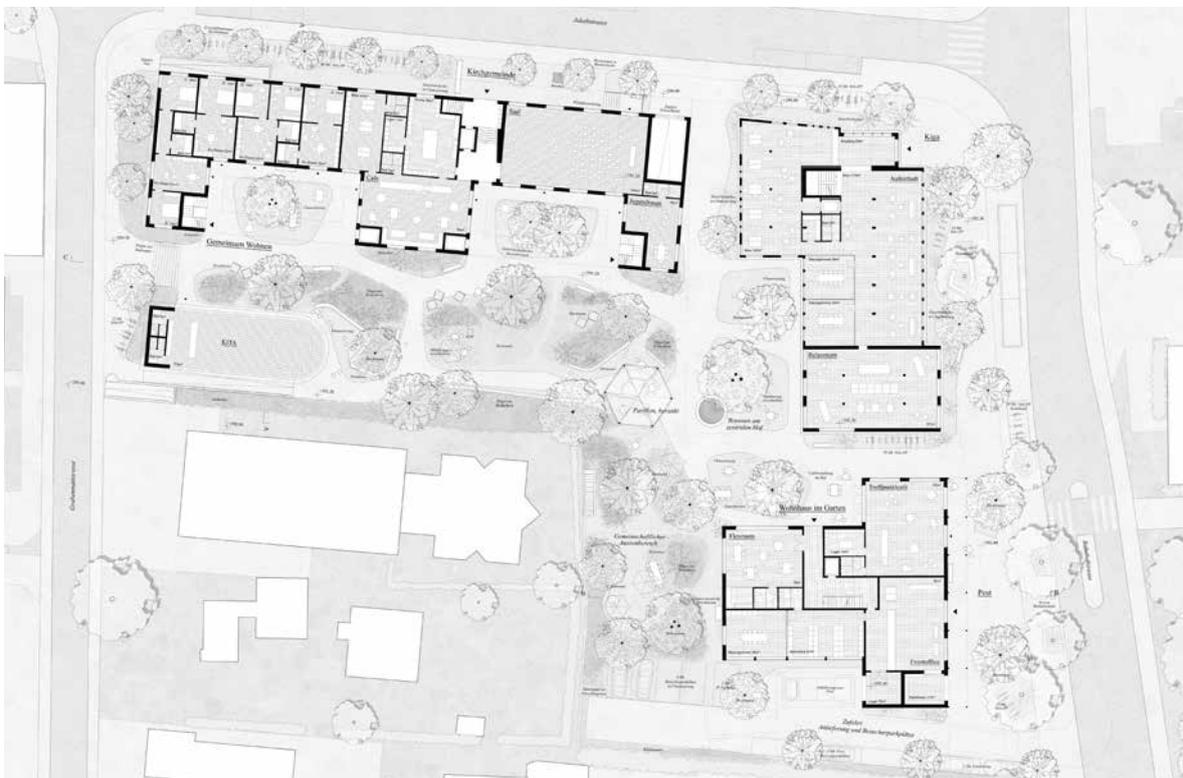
Grundriss EG mit Freiraumgestaltung
